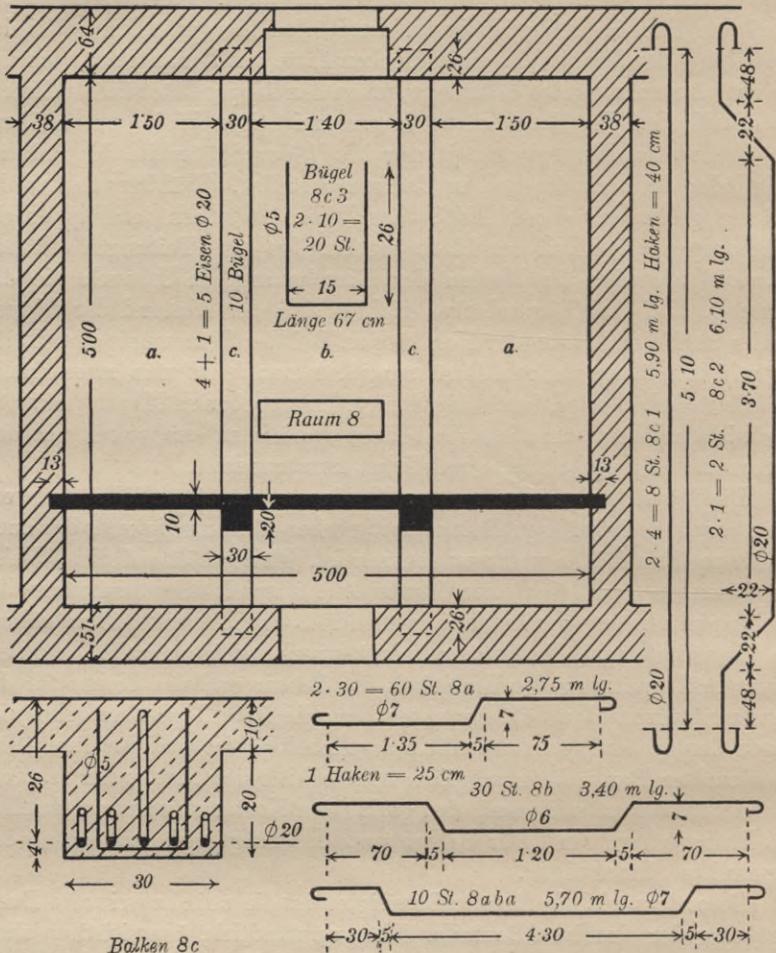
Zeichnung einer einfachen Eisenbetondecke mit Angabe der nötigen Eiseneinlagen.
